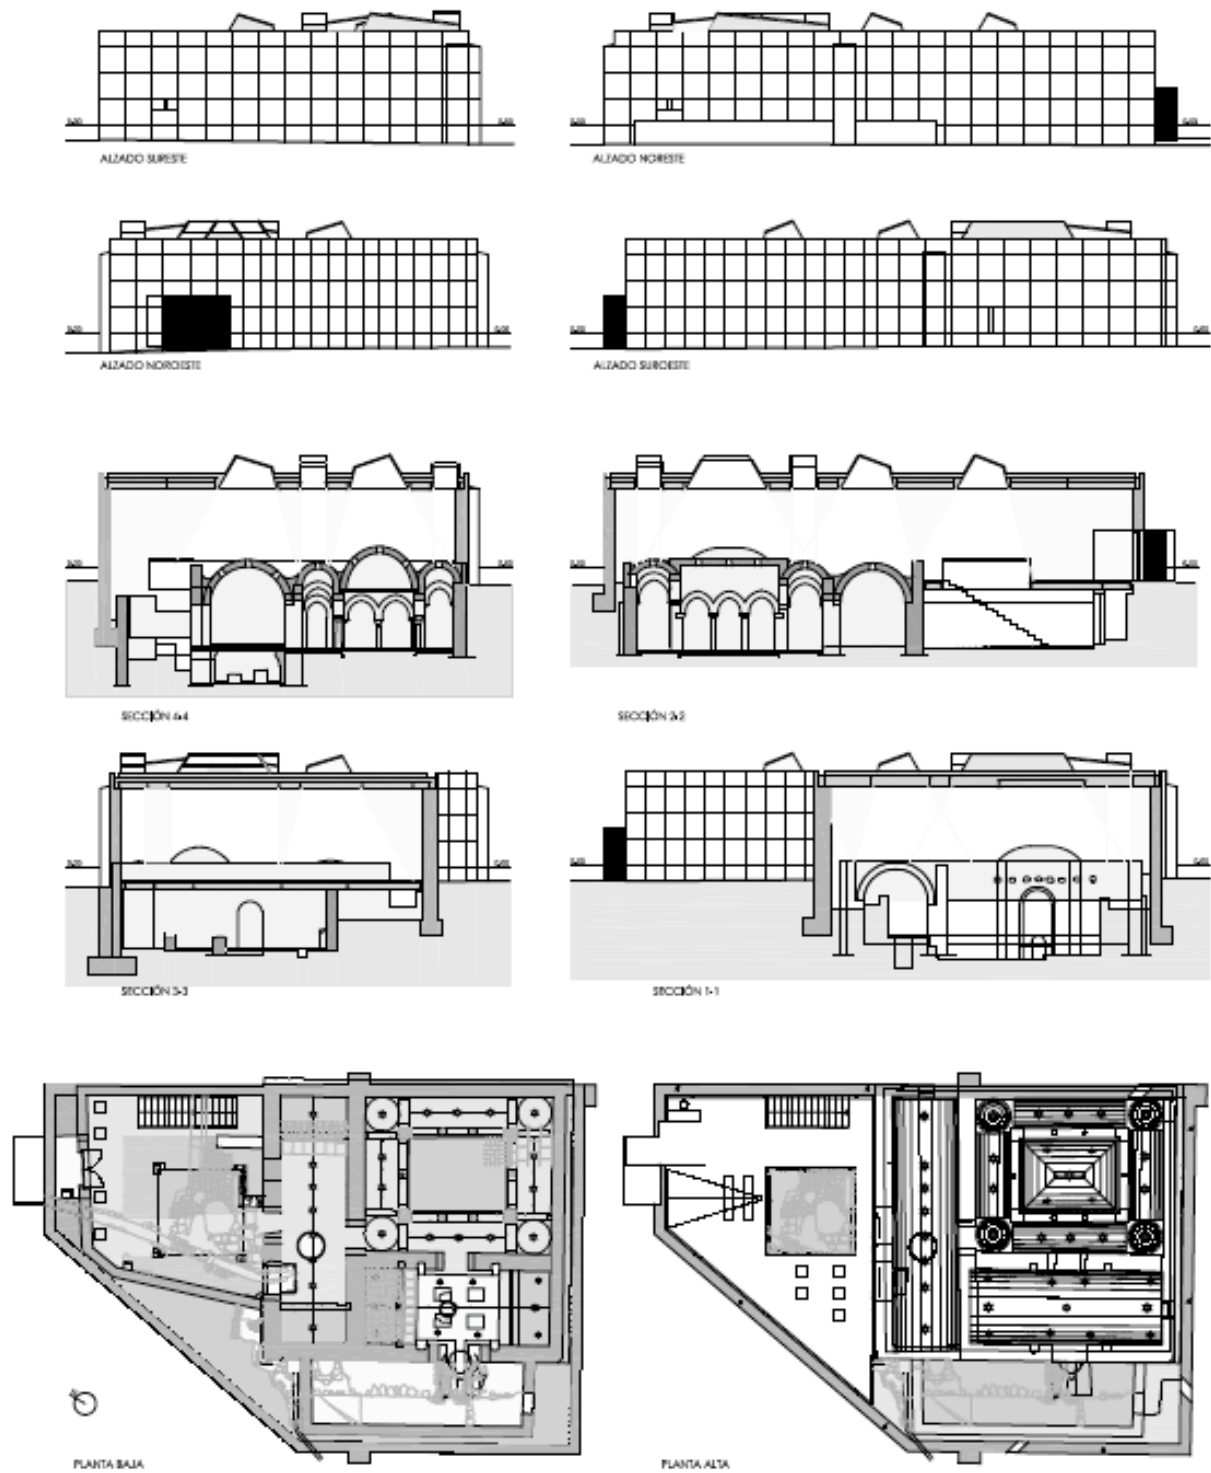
Alzados, secciones y planos del contenedor creado para proteger los Baños Árabes. (Ibáñez, 2010)
